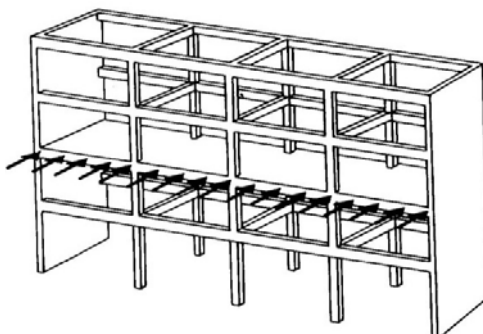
Contribución de la losa frente a acciones horizontales.
